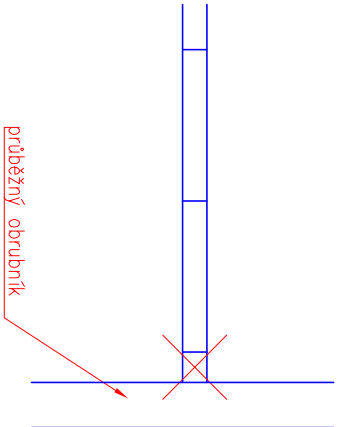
DETAIL DOŘEZÁVÁNÍ OBRUBNÍKŮ
